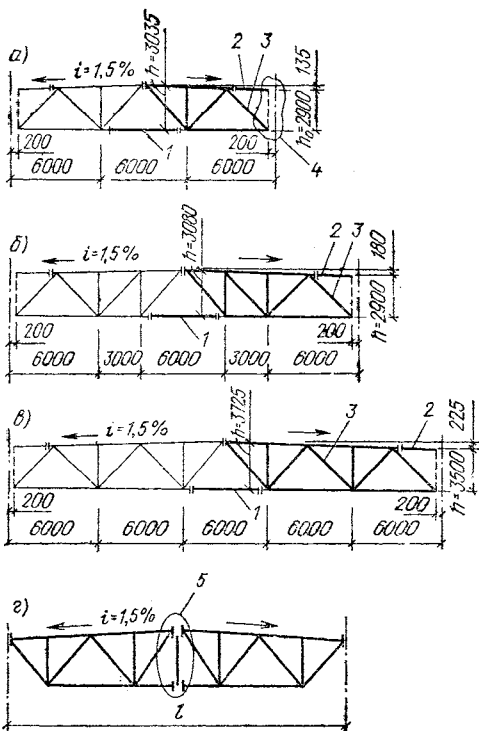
Схемы унифицированных трубчатых стропильных ферм
